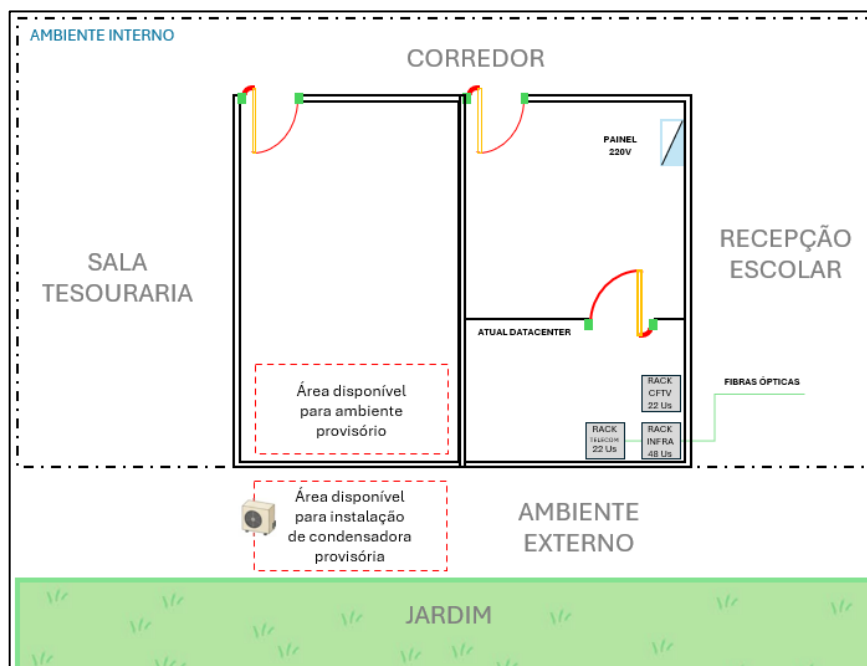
Planta baixa atual do espaço disponível para construção do datacenter em sala modular e área para o ambiente provisório
